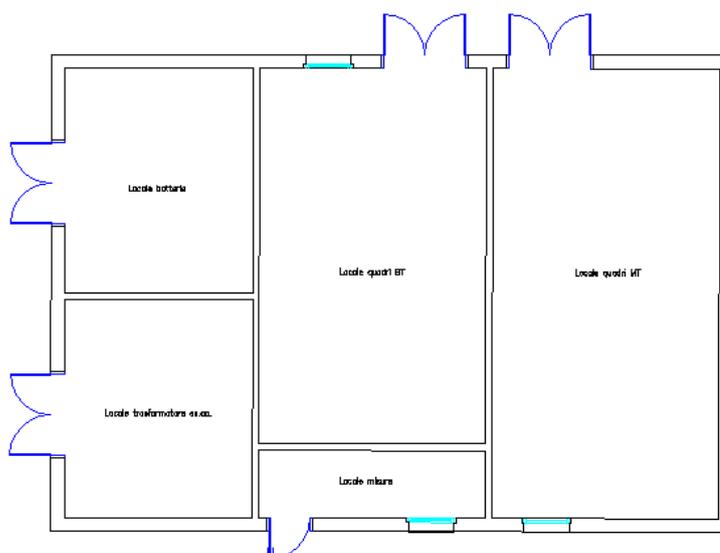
Planimetria primo locale quadri MT della Stazione Utente
